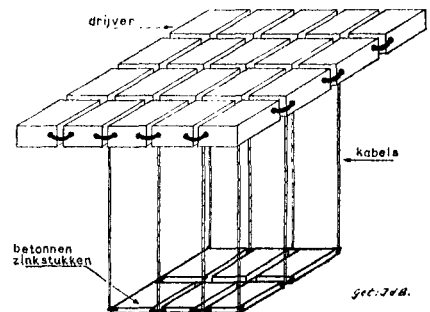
Schets van een betonnen zinkstuk met houten drijvers.
